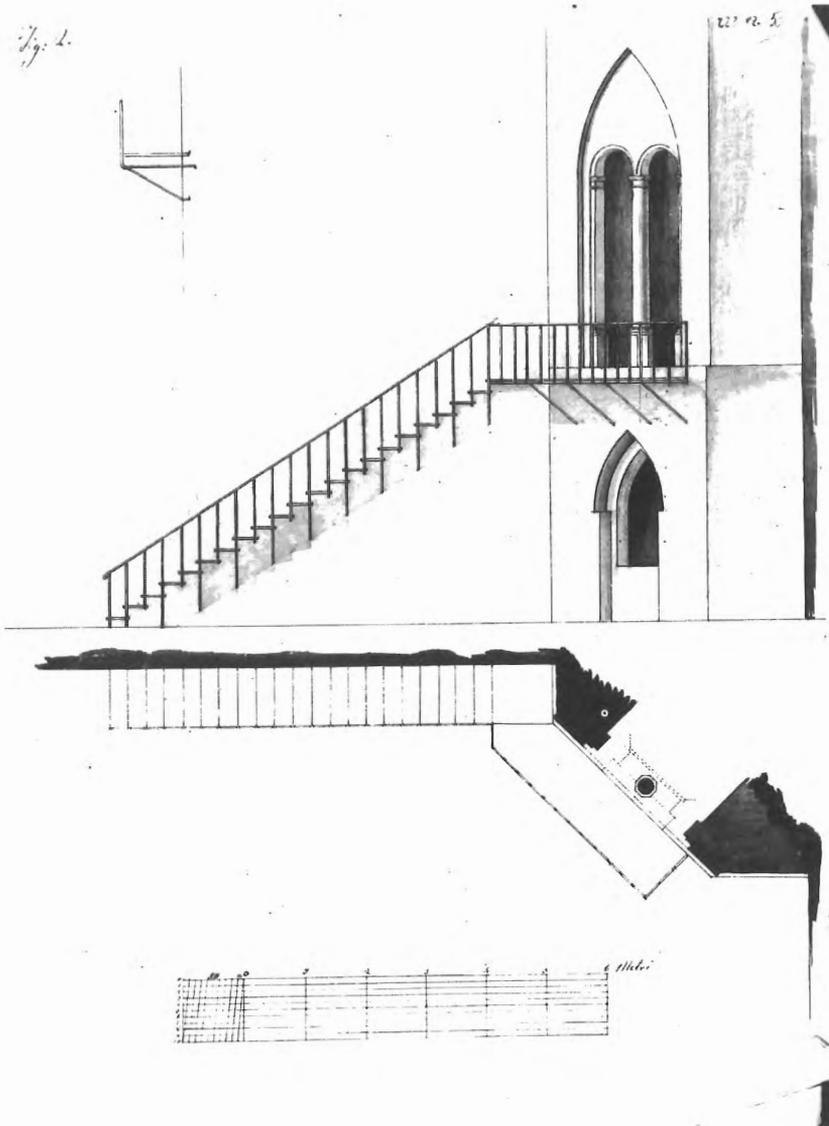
Progetto di realizzazione dello sporto della Sala Lapidaria Pianta e prospetto (BSF, Fondo Piancastelli, Carte Romagna, busta 223, c. 50).
